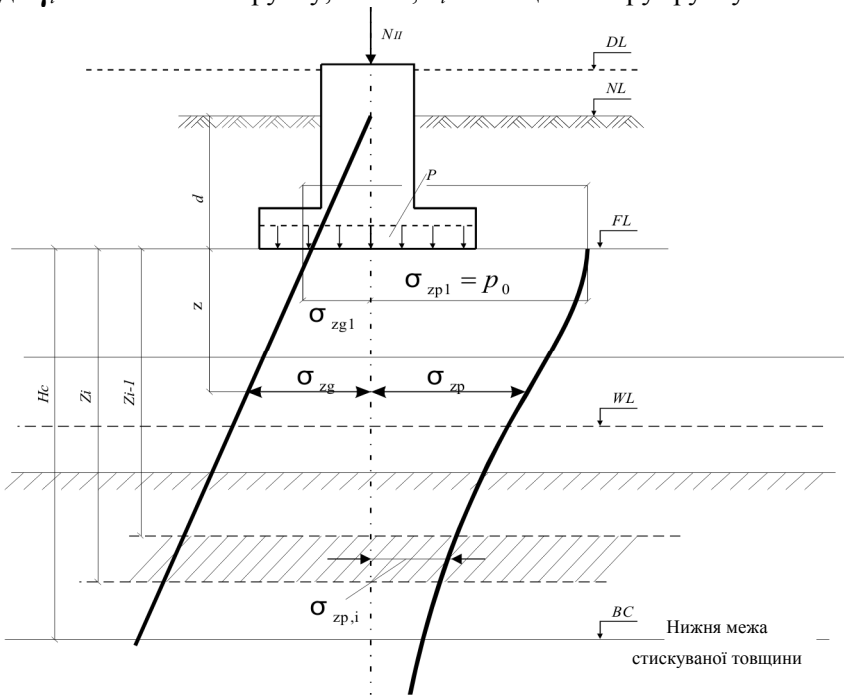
Схема до розрахунку осідання методом пошарового підсумовування
